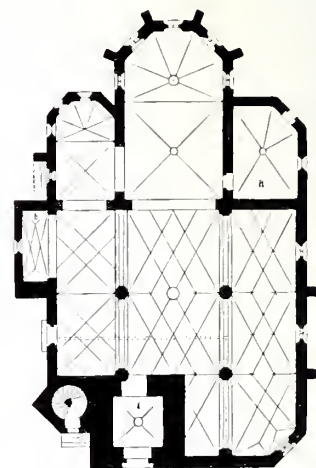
Hollenburg, Pfarrkirche, Grundriß 1:500 (S. 169)
